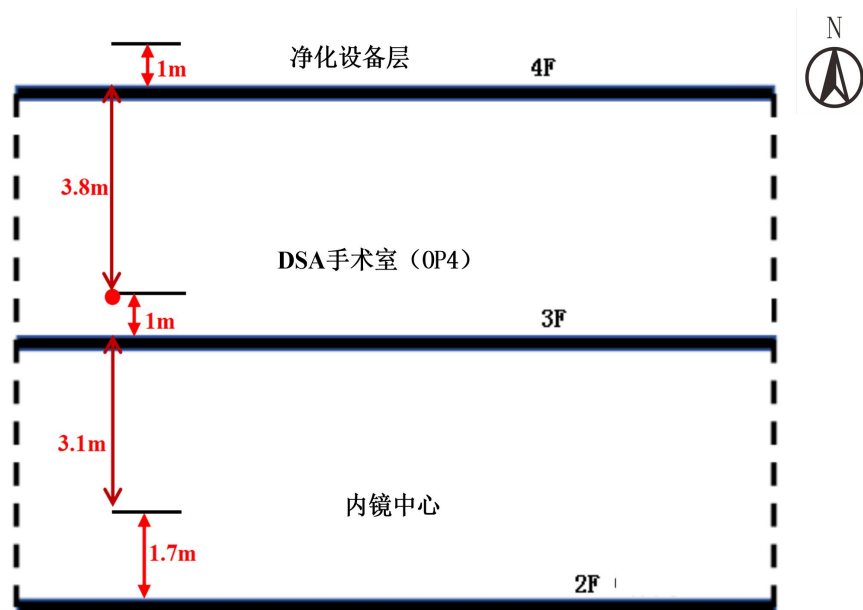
(b) 本项目 DSA 手术室 (OP4) 平面辐射屏蔽设计剖面图
